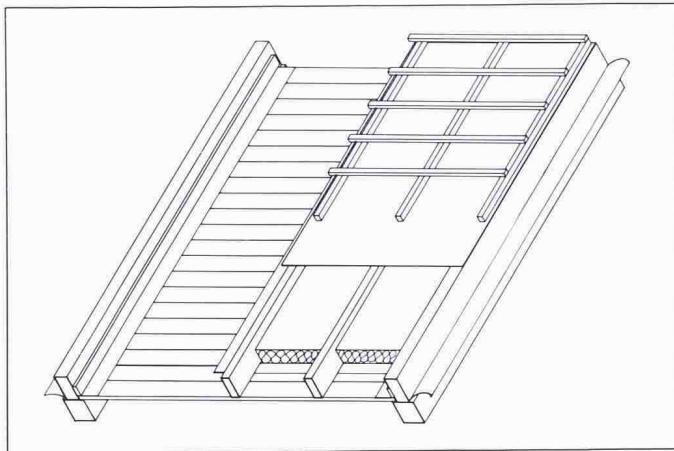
Prinzip des Dachaufbaus von innen und aussen: Schalung, Dampfsperre, Sparrenlage, Wärmedämmung, Unterdach, Lattung und Konterlattung
